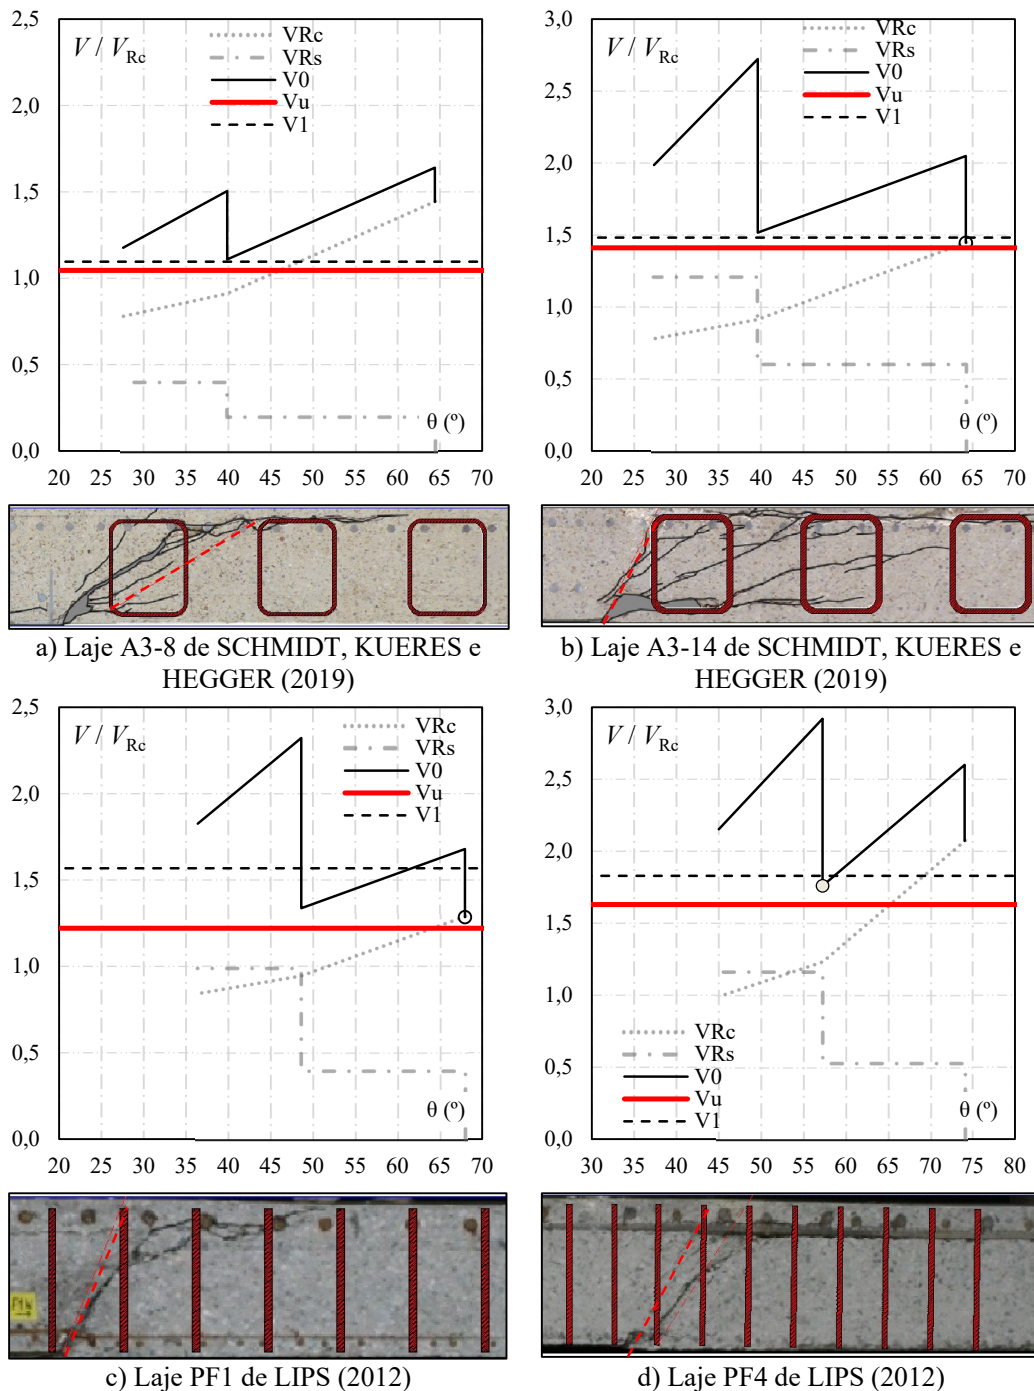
Verificações de SMRC para lajes com estribos bem ancorados.
